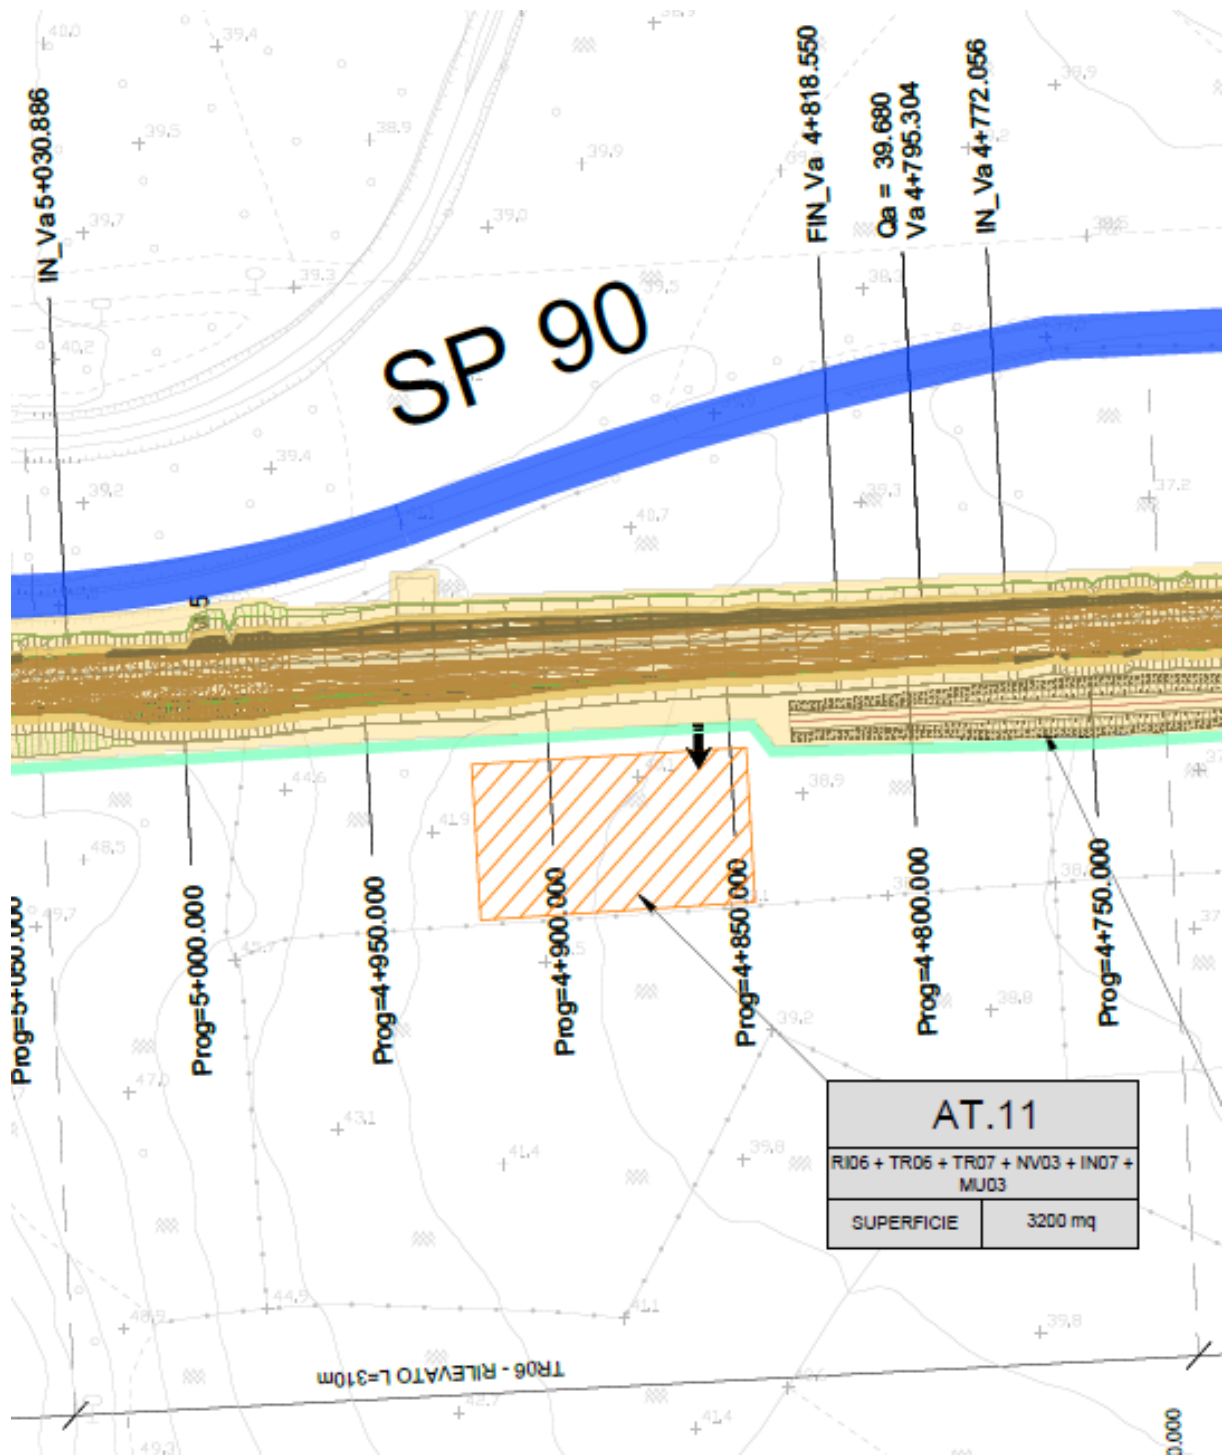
Vista in pianta dell'area di cantiere AT.11
